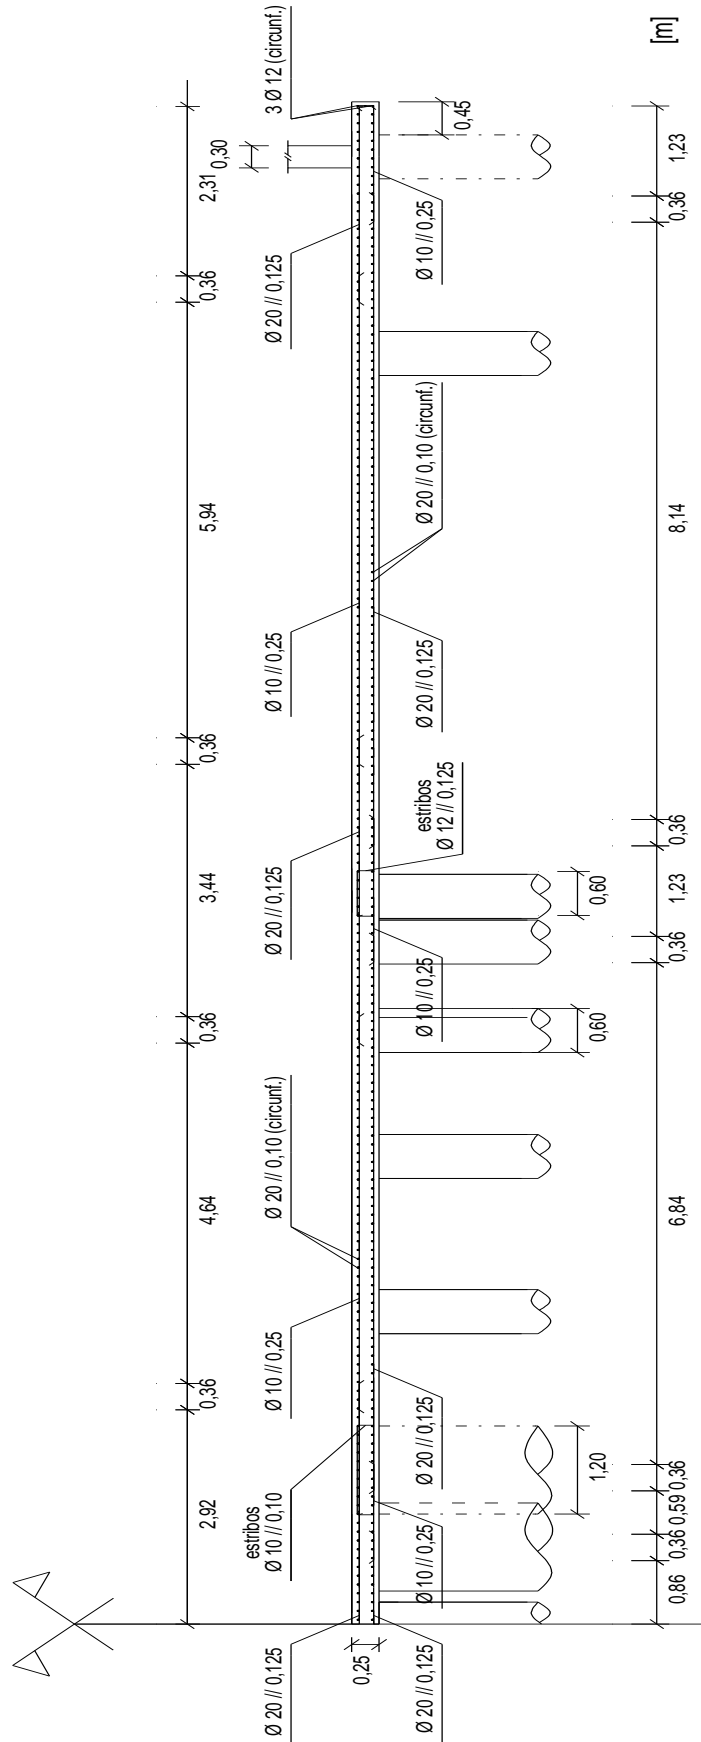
Corte A-A representativo da disposição das armaduras existentes na laje de fundo do reservatório.
